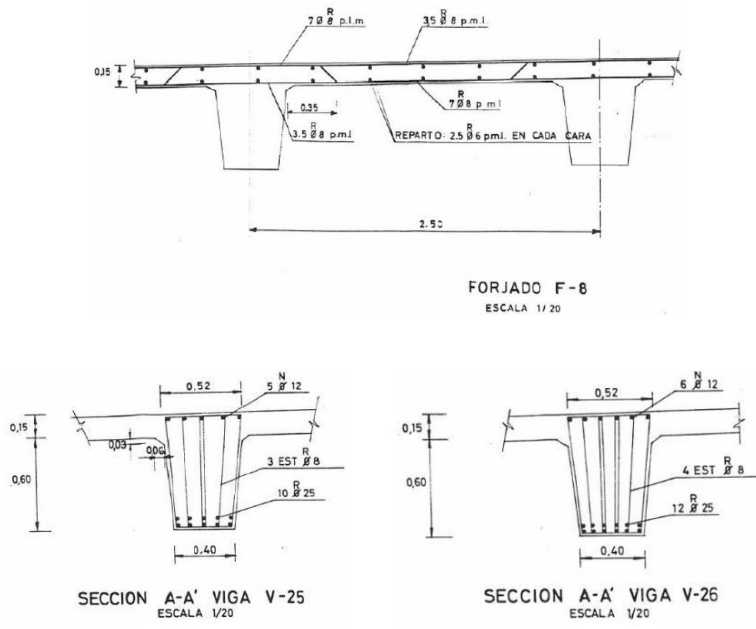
Detalles de sección de armado de forjado y vigas de la planta -2 del aparcamiento
